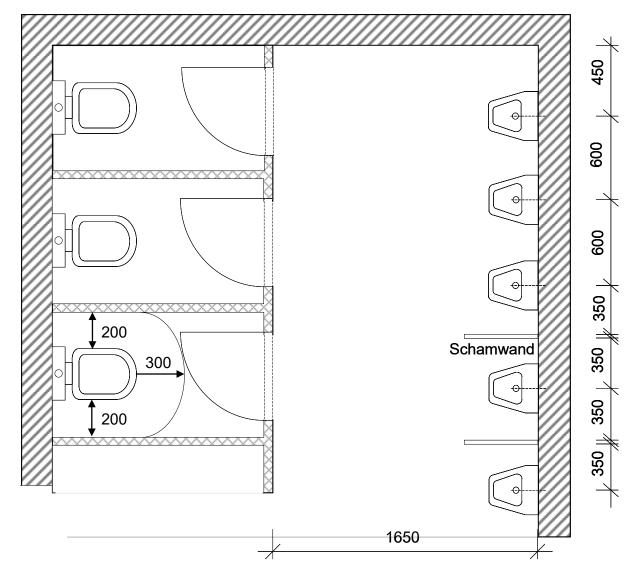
Einbündige Toilettenanlage mit Urinalen, Türanschlag nach innen (Maße in mm)
